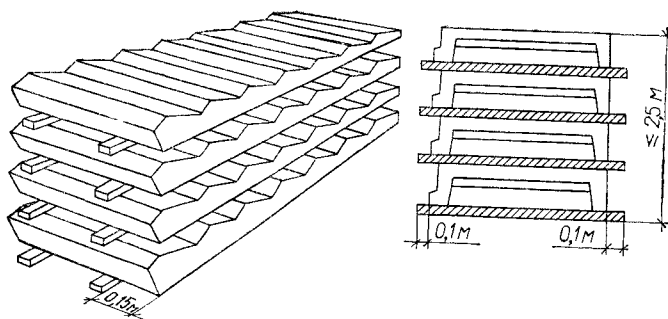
Лестничные марши и площадки — на подкладках и прокладках.
